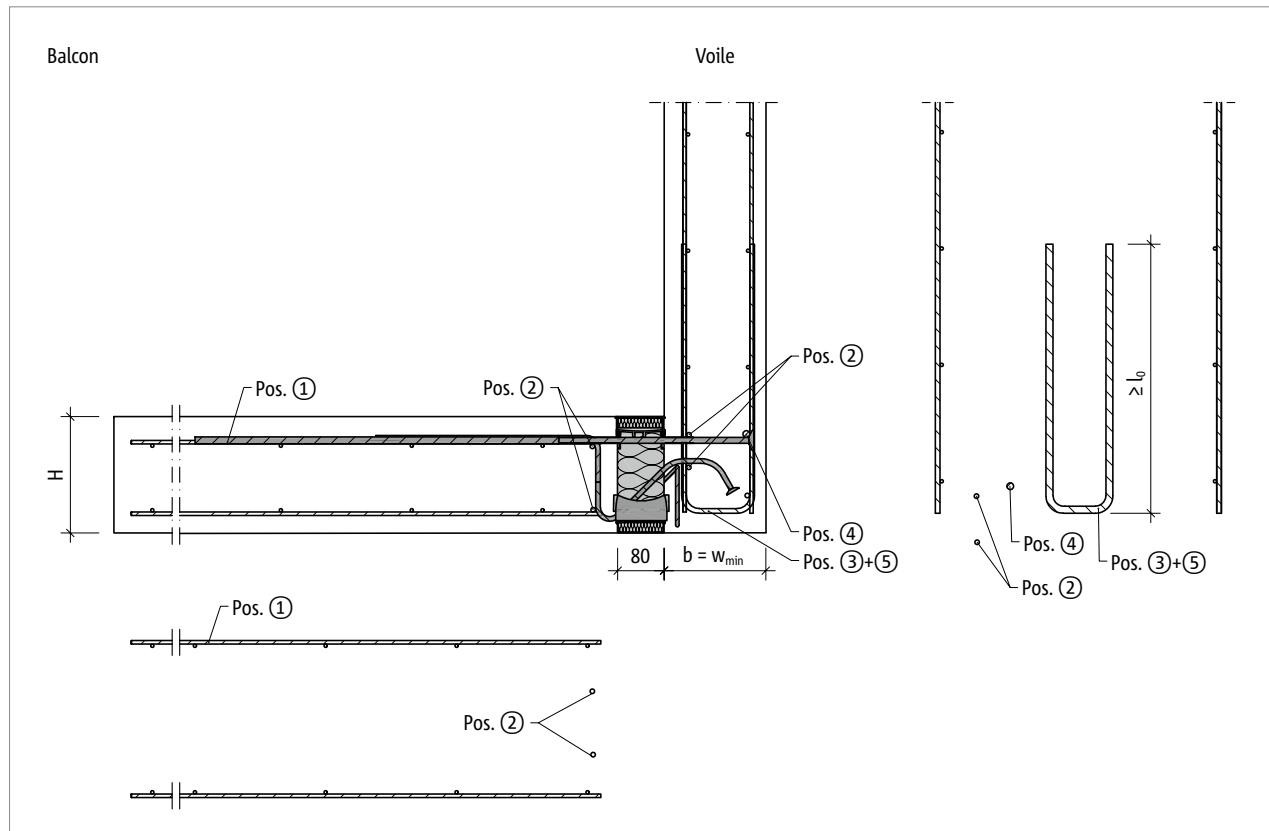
Schöck Isokorb® T type K-U : Renforcement sur site pour raccordement mural avec une dimension minimale du composant ($w_{prés} = w_{min}$)
